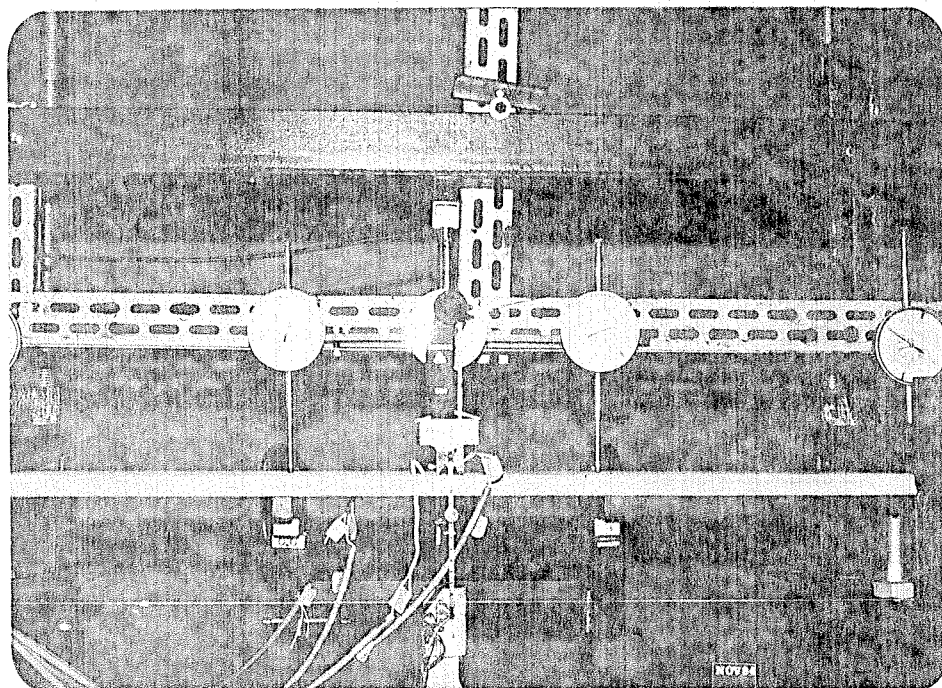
Vista geral da instrumentação posicionada em viga a ser ensaiada à flexão. A frente do defletômetro central está posicionado o extensômetro mecânico para medição dos alongamentos da argamassa.
